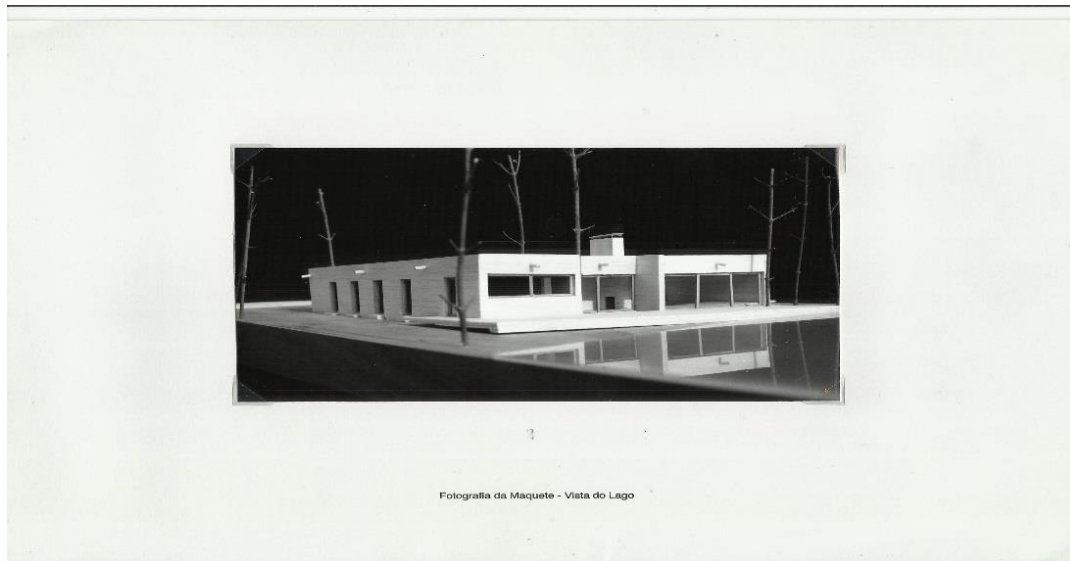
Volumetria do edifício depois de construído - Vista do lago,
